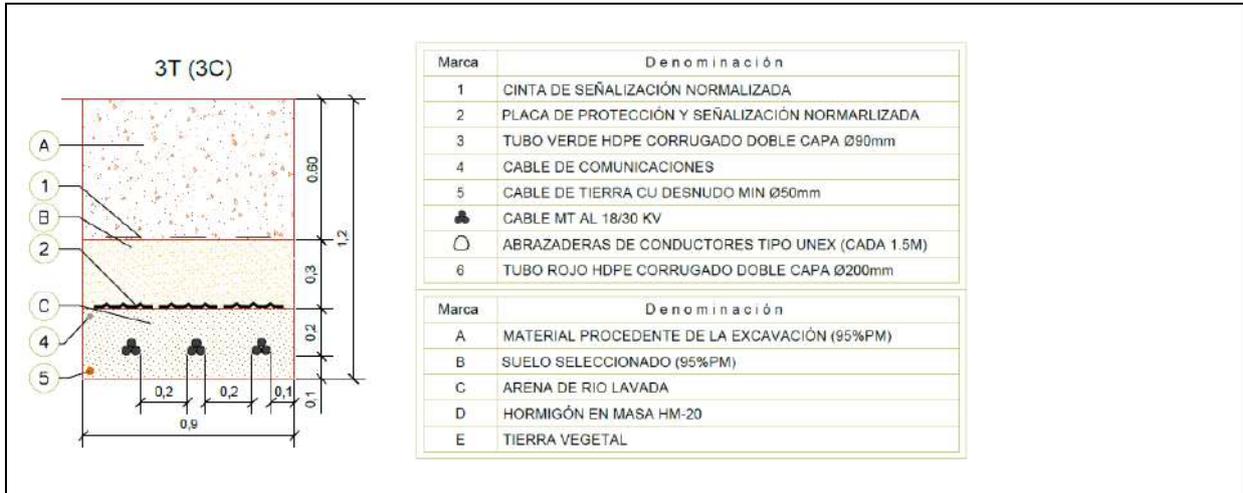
Detalle Sección Zanjas Tipo 3T. Conductor directamente enterrado
